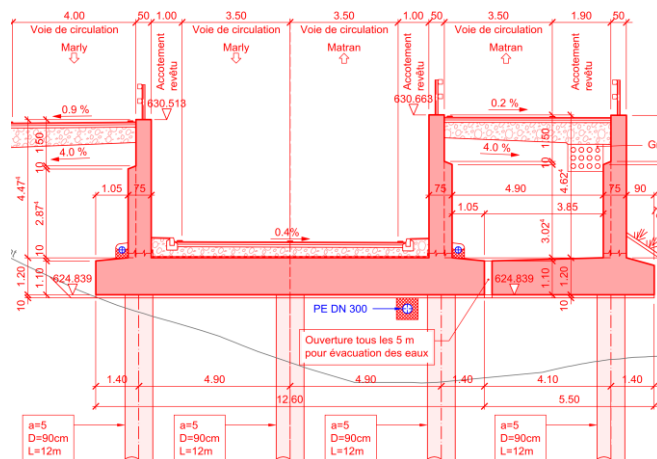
Coupe type de la trémie du PI Crausa avec mur adjacent
